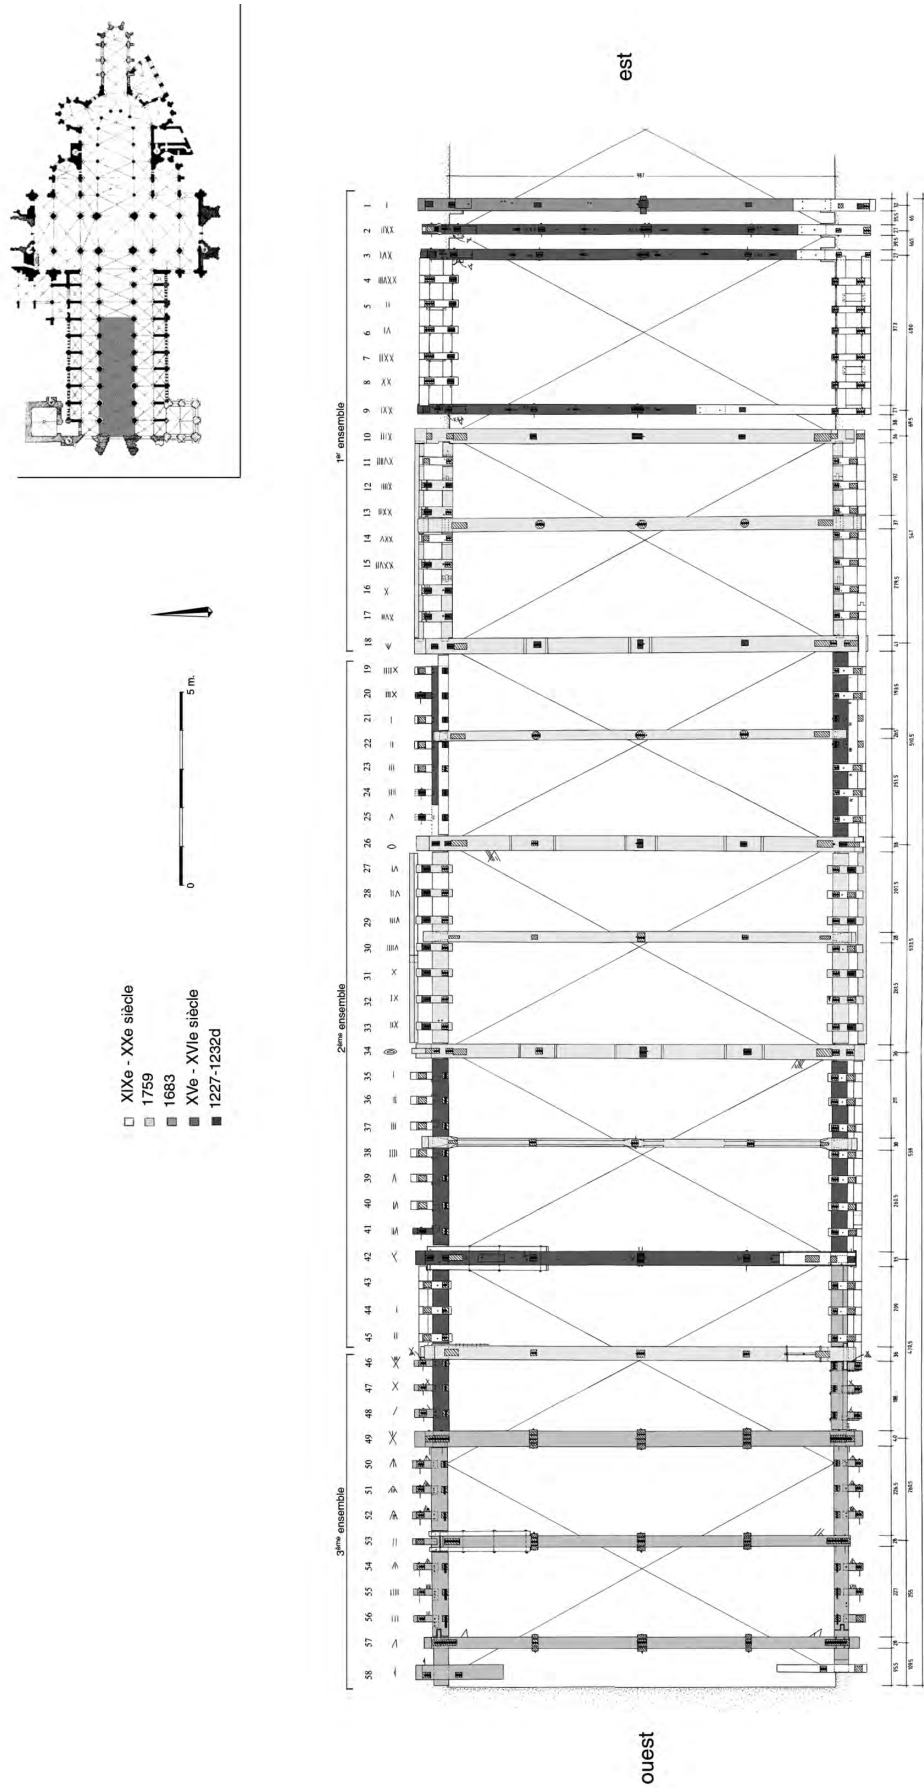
Plan de la charpente de la nef au niveau des entrails.
